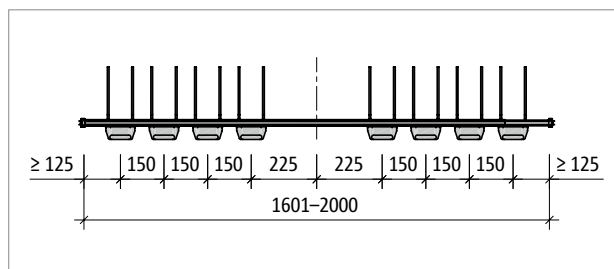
Schöck Tronsole® typ T-V7...-L1150 až L1450: Půdorys prvku
